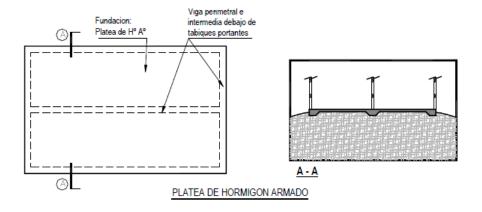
Componentes estructurales de una platea de hormigón armado. Fuente: (ConsulSteel, 2014).
